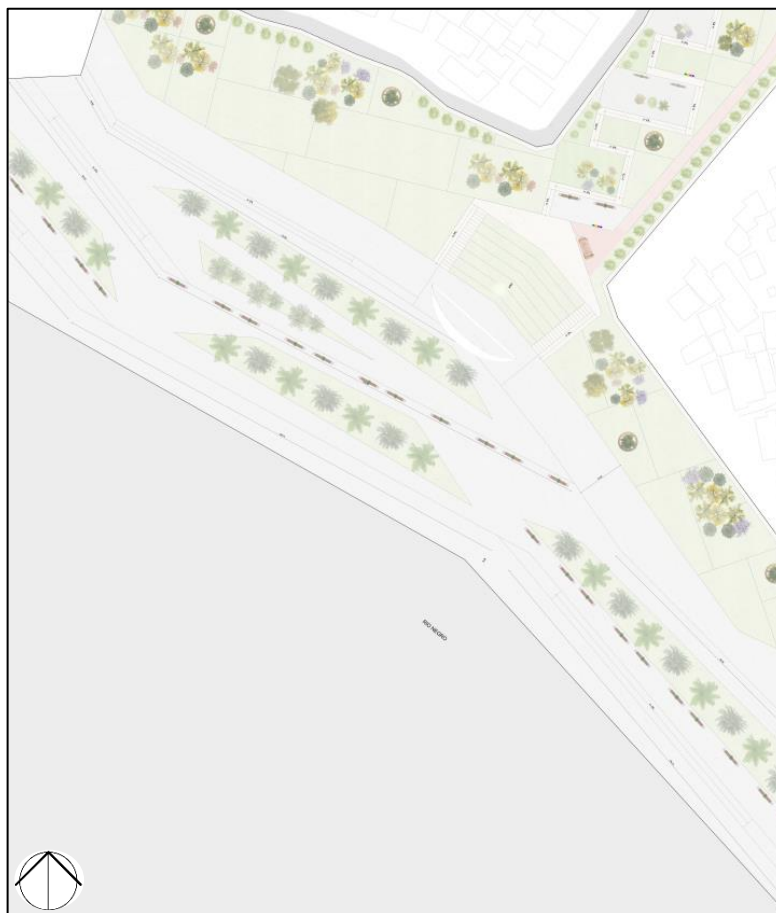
Planta-baixa Setor 5. Fonte: Elaborado pela autora.
